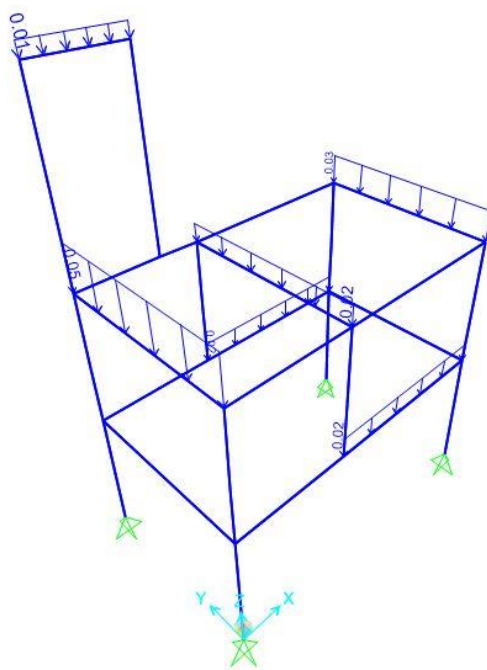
Esquema de la estructura con cargas asignadas en SAP2000
